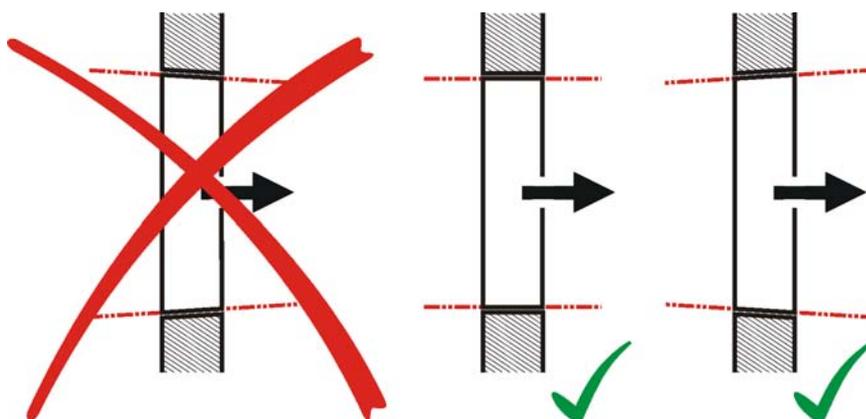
Remoção com cortes perpendiculares e ligeiramente cónicos.
